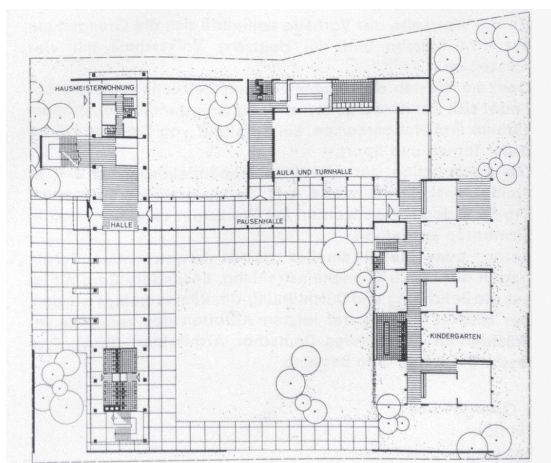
Anteproyecto del conjunto del Colegio Alemán de Valencia, planta baja (1960).
